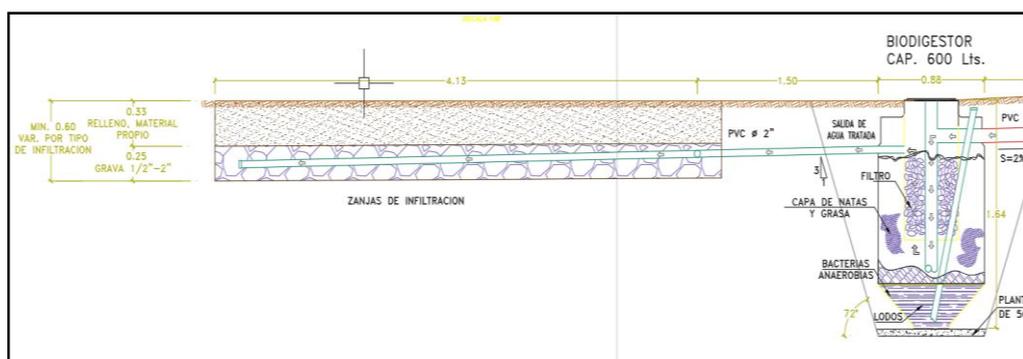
PERFIL DE ZANJA DE INFILTRACIÓN.
